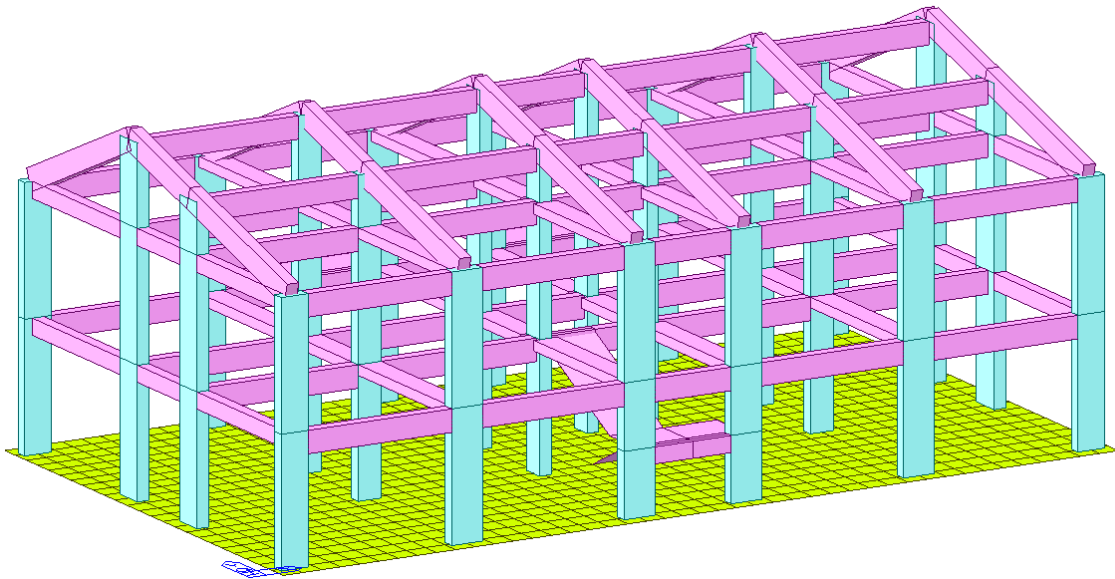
Modello FEM edificio a due piani in c.a. con platea di fondazione - Vista assometrica 1.
